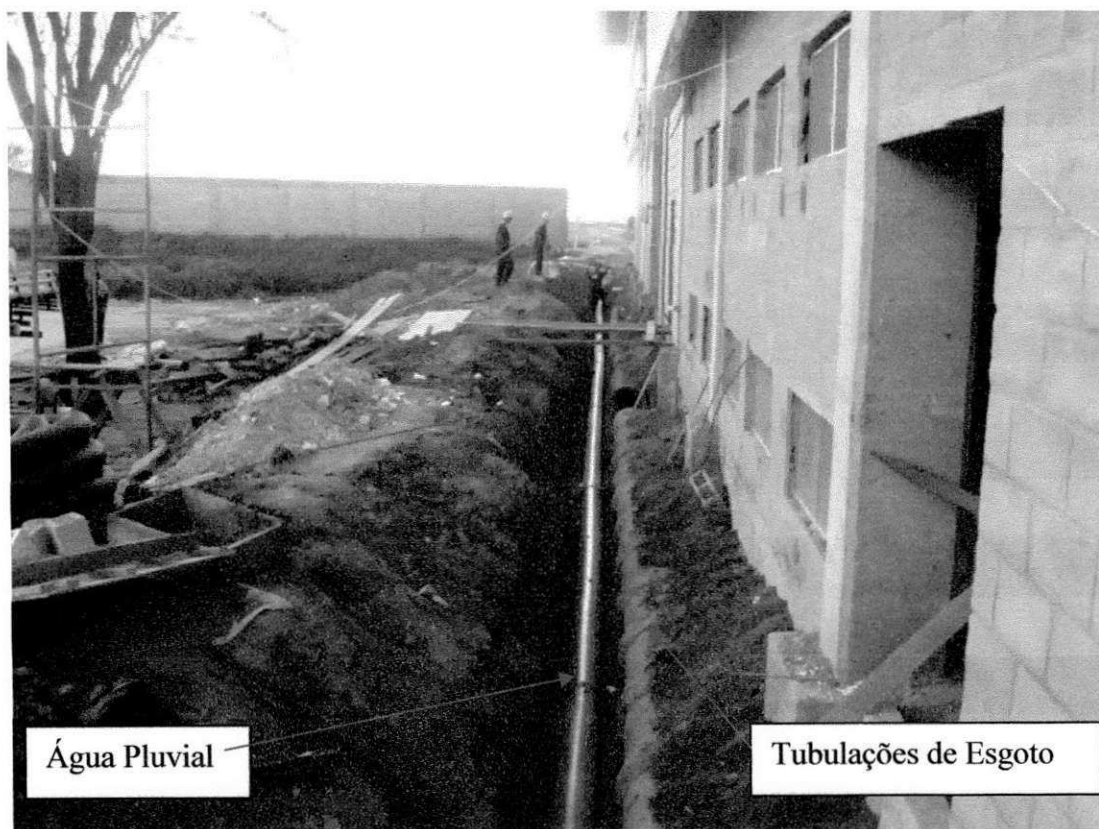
Tubulação de Água Pluvial e de Esgoto
